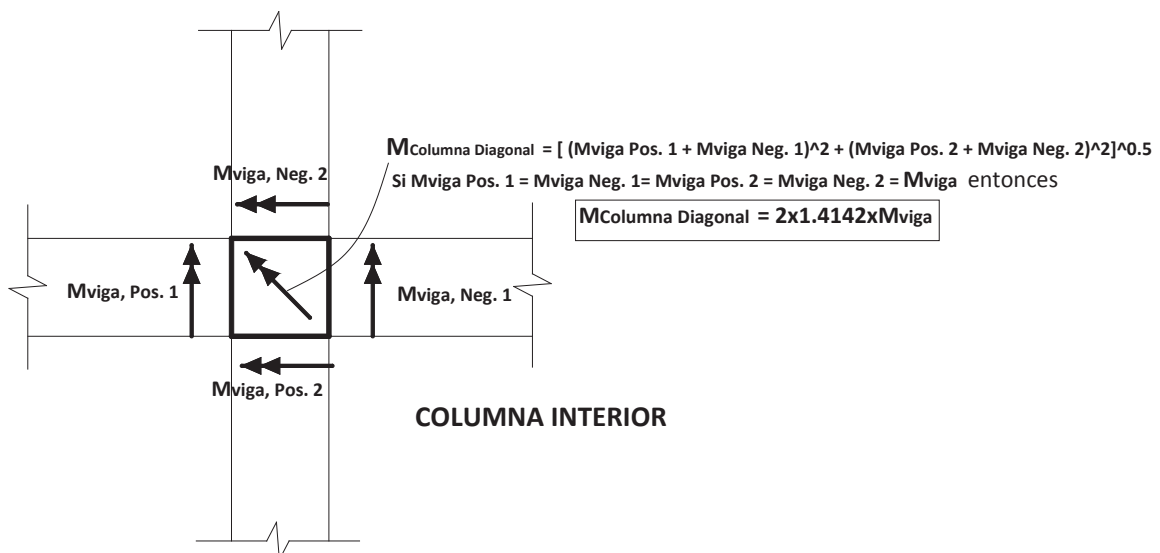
a Momento Columna Interior (ataque bi-direccional)
